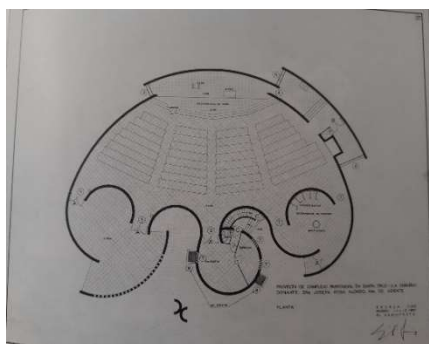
Fisac. Santa Cruz de Oleiros, planta (La Coruña), 1967.
